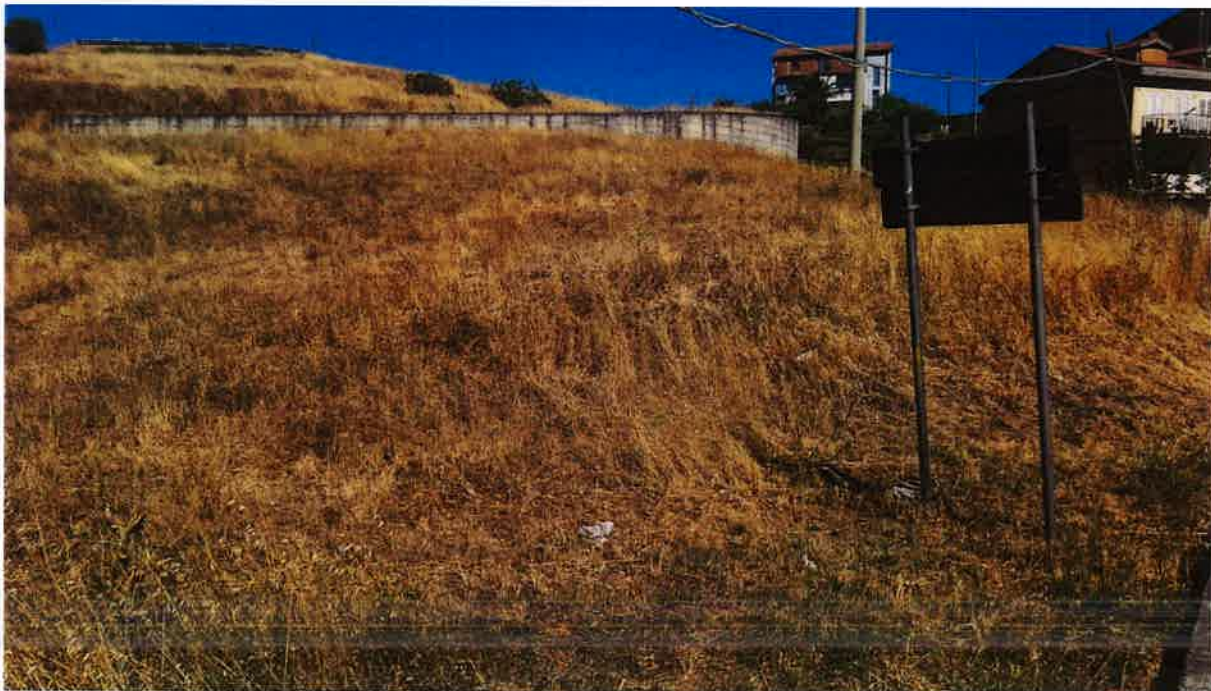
Vista centrale del terreno (C) fg.24 part. 213, contrada Castile
